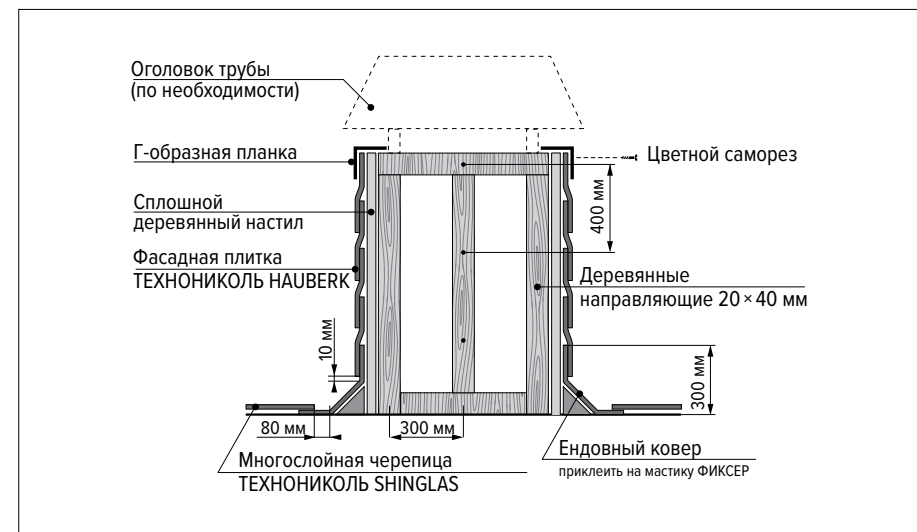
Монтаж фасадной плитки на вентиляционную трубу
